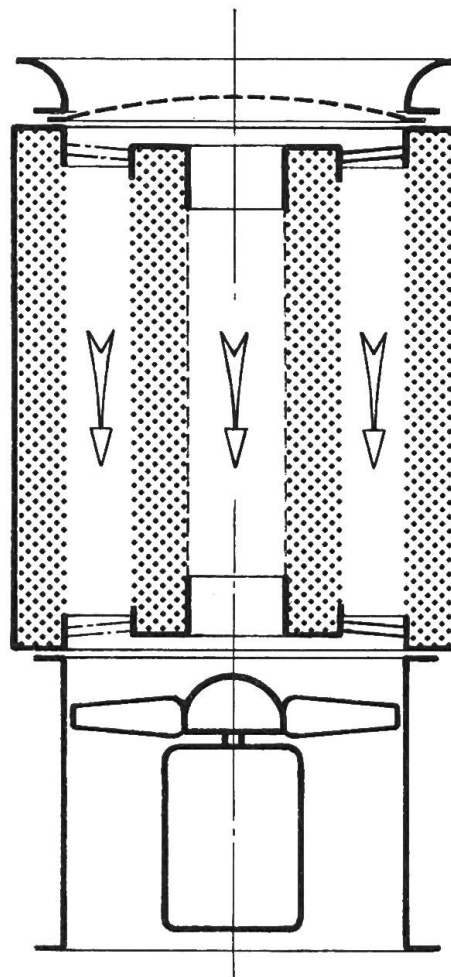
Ventilateur Woods 19 JR comportant un amortisseur de bruit 19 CA (avec dispositif central d'isolation du son).
